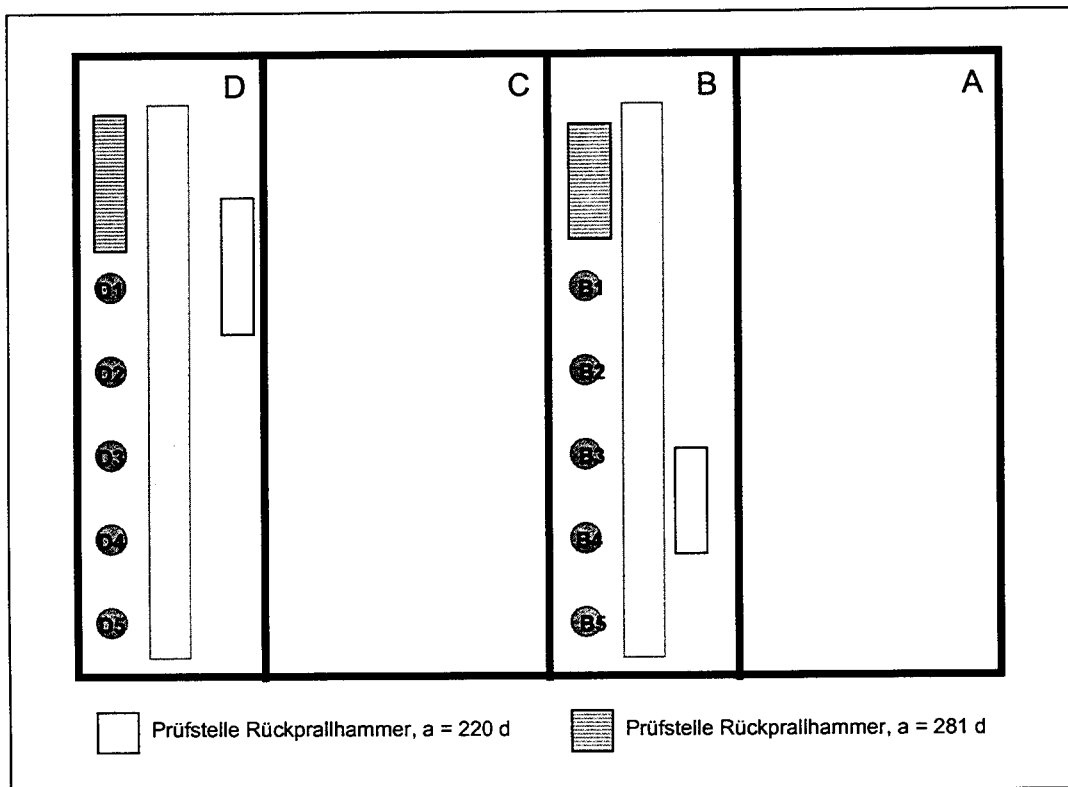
Lage der Prüfflächen am Betonkörper 20
